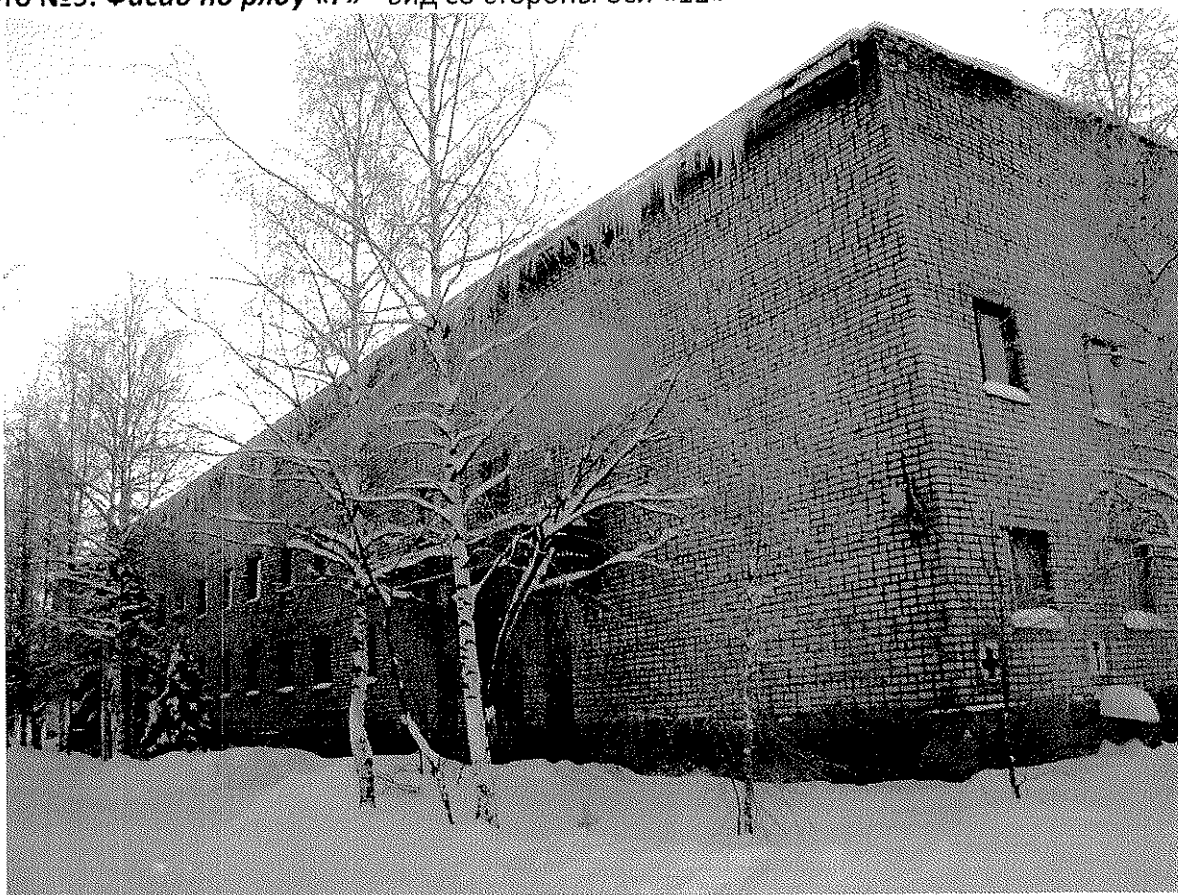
Фасад по ряду «Г» - вид со стороны оси «1»
